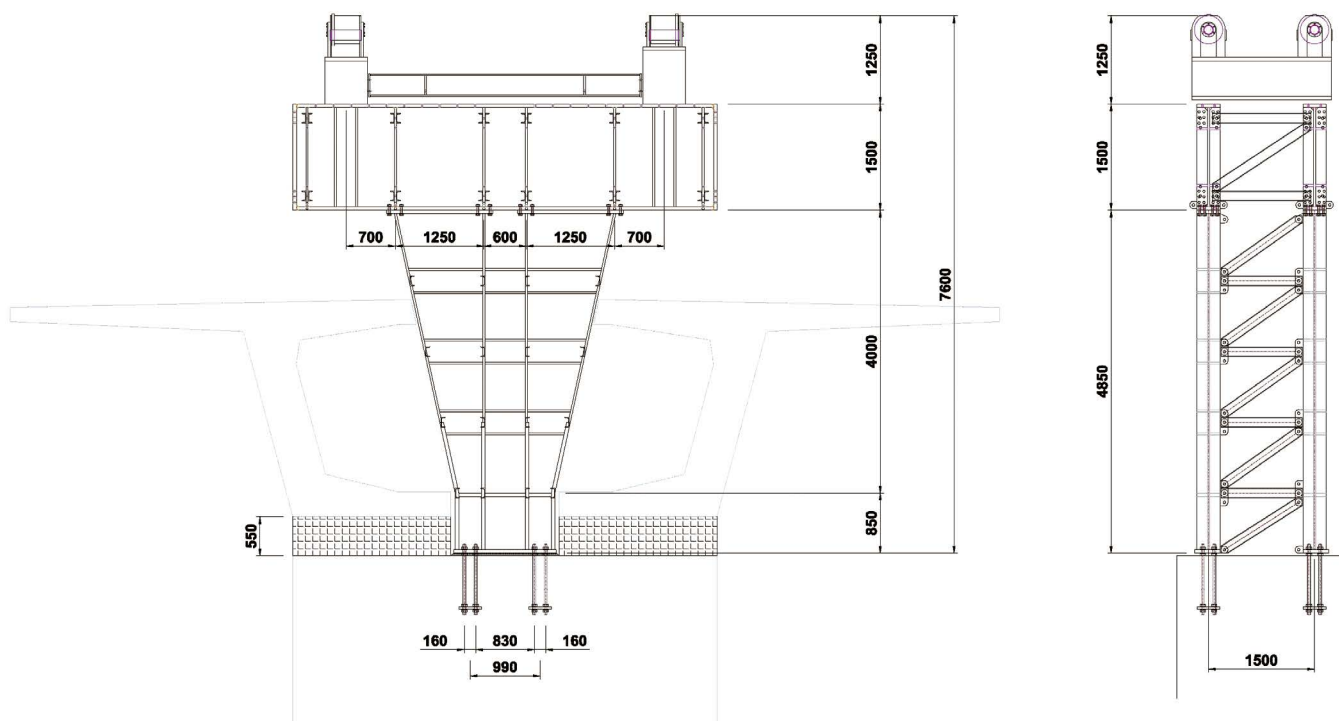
Croquis del pórtico de apoyo en pilas principales (P6 y P15).
